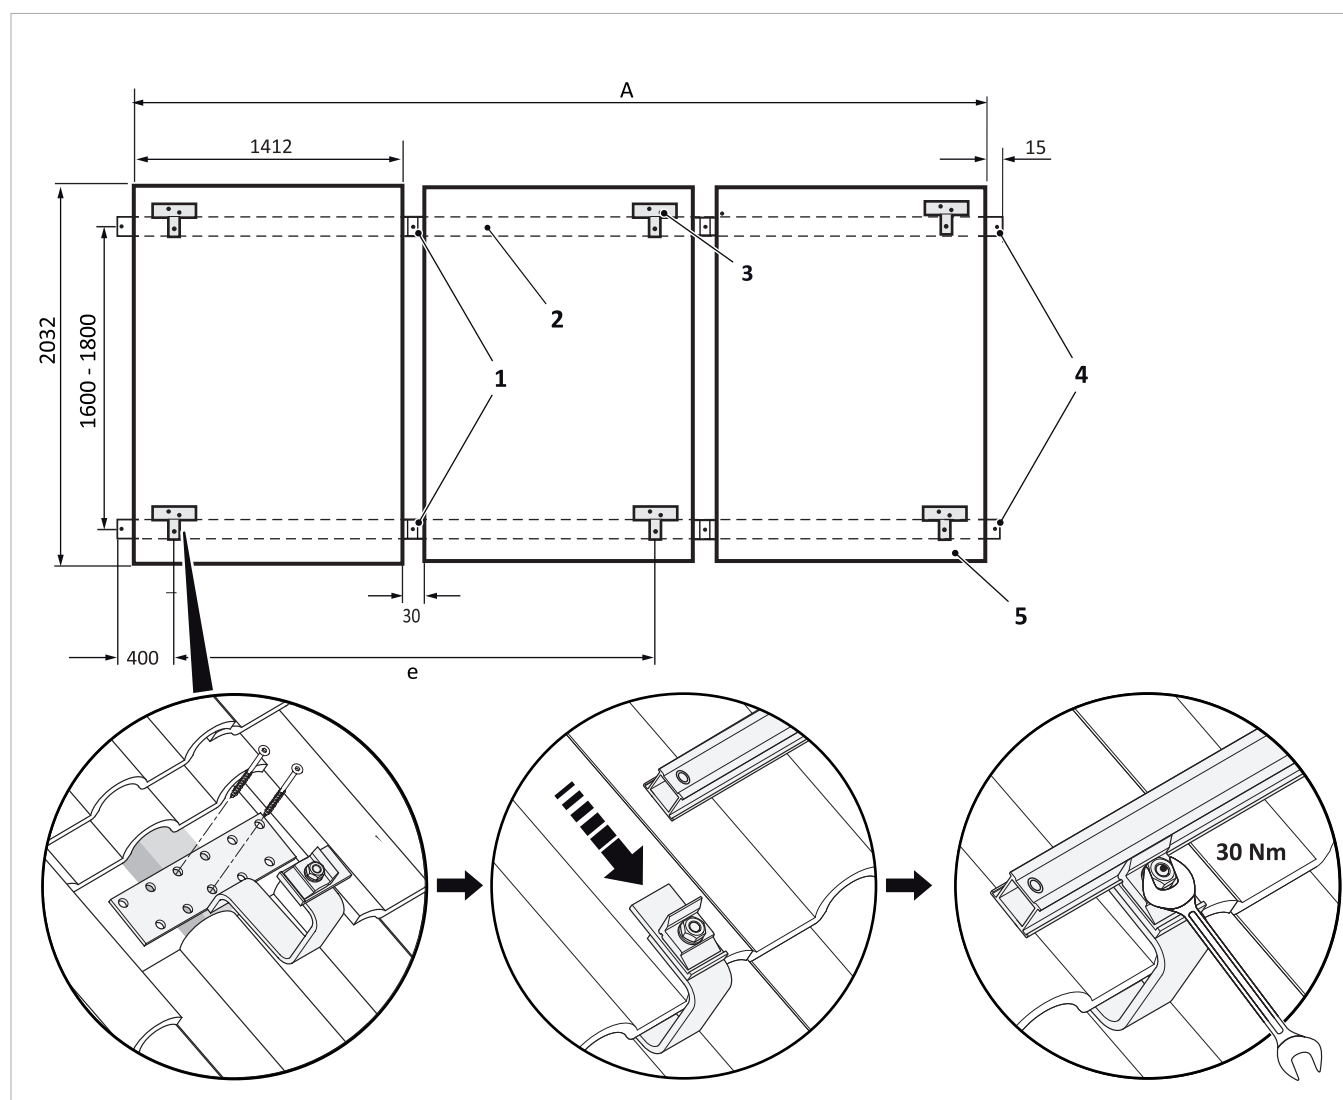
montage juxtaposé des fixations sur toiture et des rails de montage
